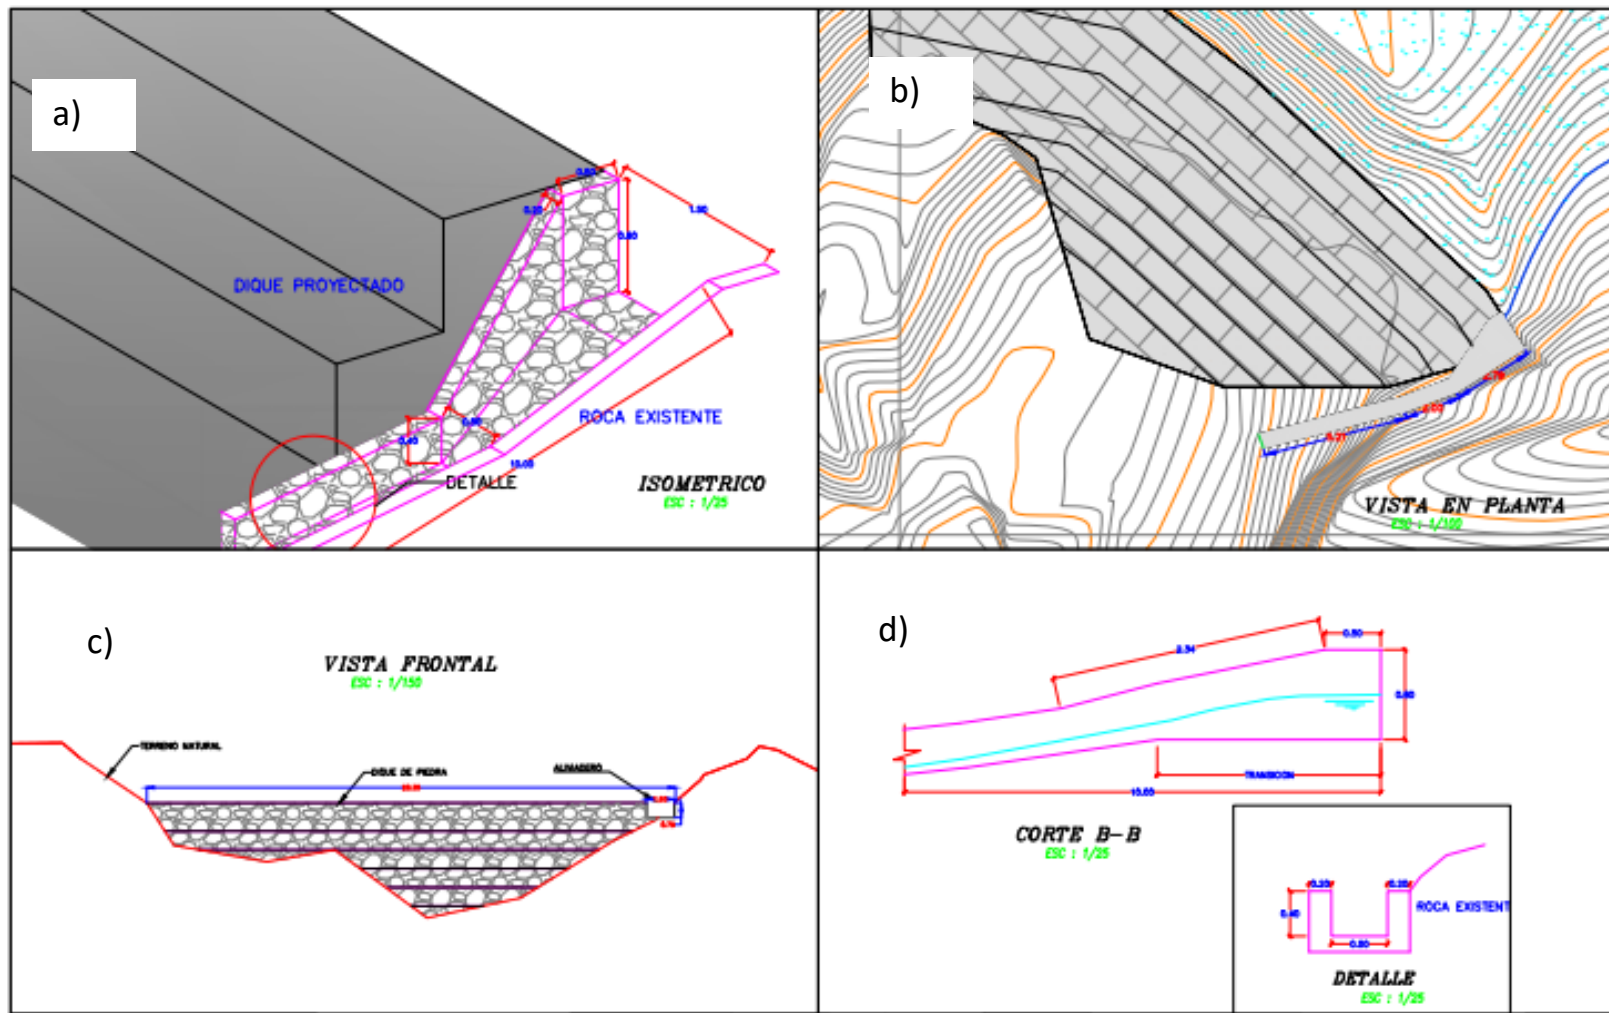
a) Vista isometrica del dique, b) Vista planta , c) Vista frontal de dique y d) Detalles de las obras conexas.
